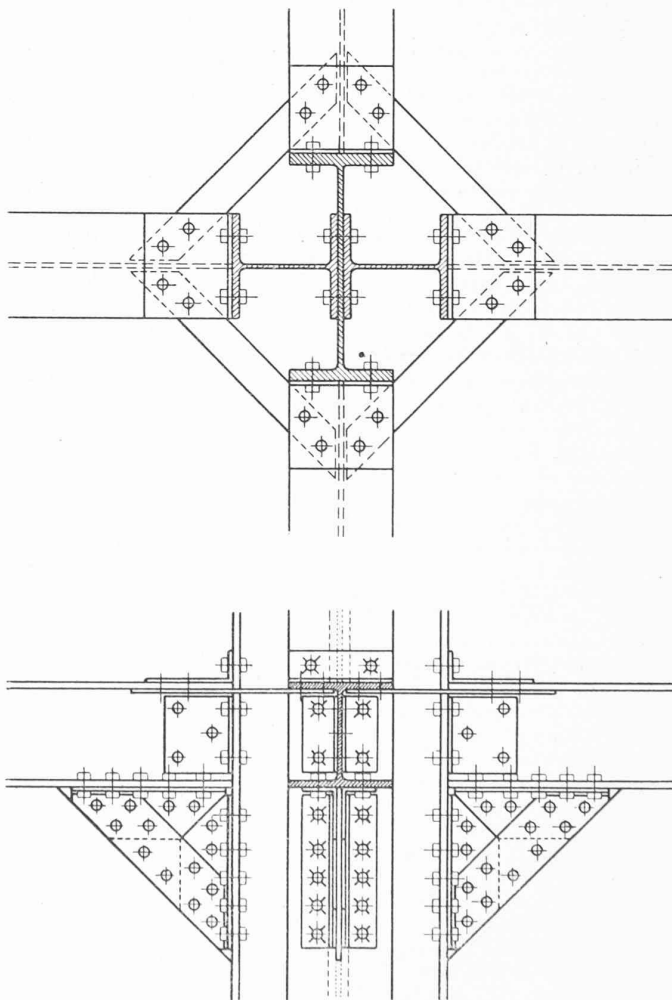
Assemblage des poutres horizontales avec les colonnes.
